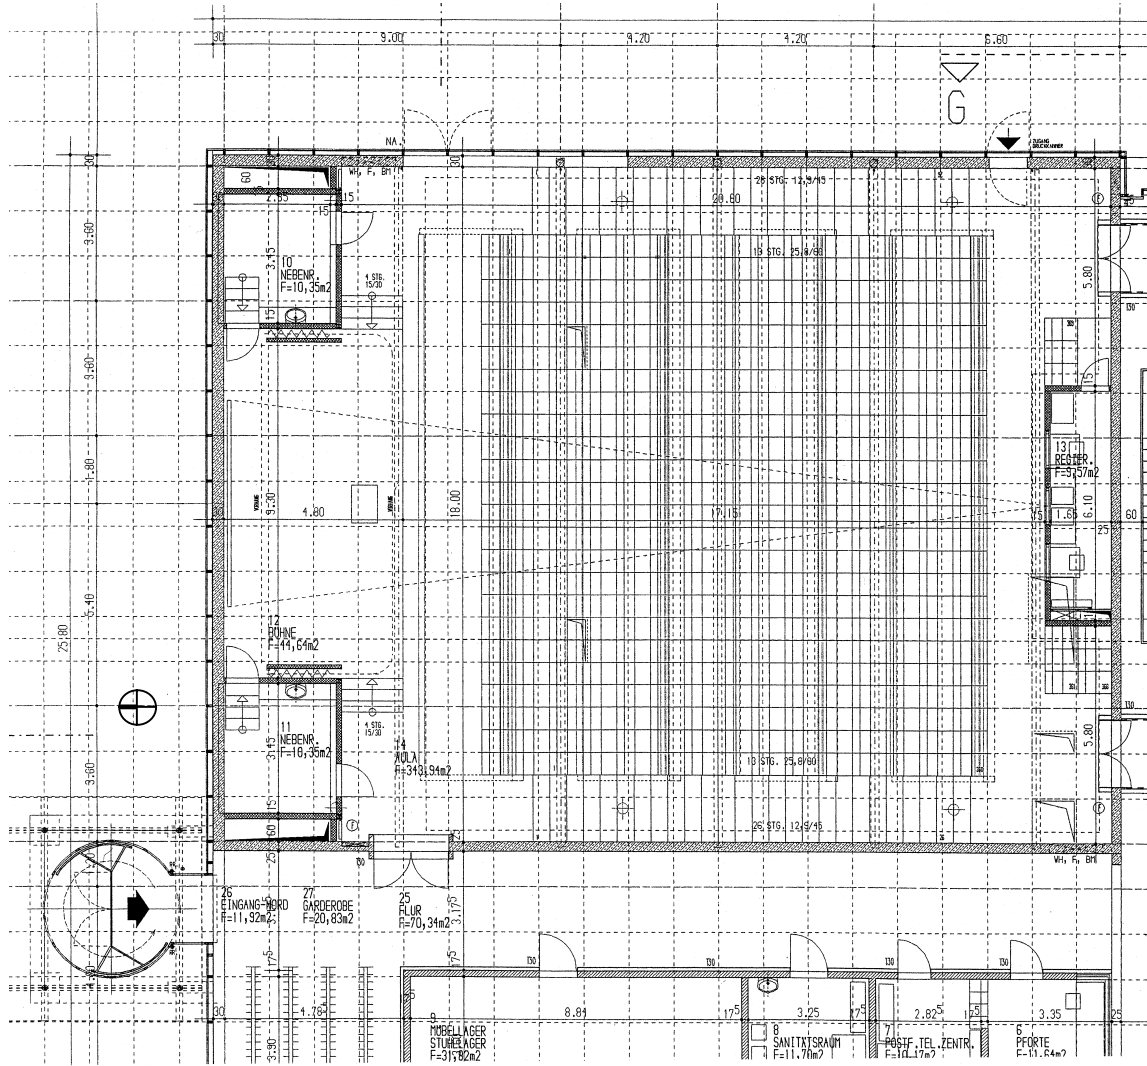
Grundriss (Maßstab ca. 1:200)
